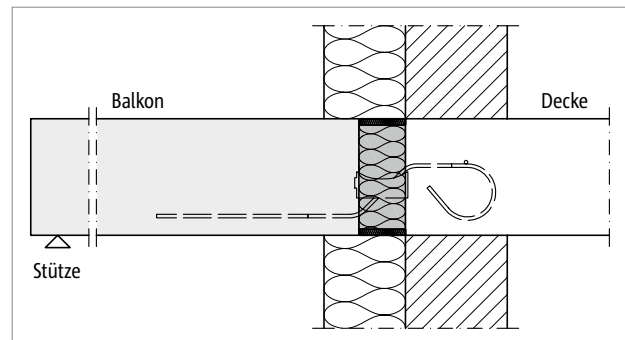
Schöck Isokorb® T Typ ZL, QL: Wärmedämmverbundsystem (WDVS)
